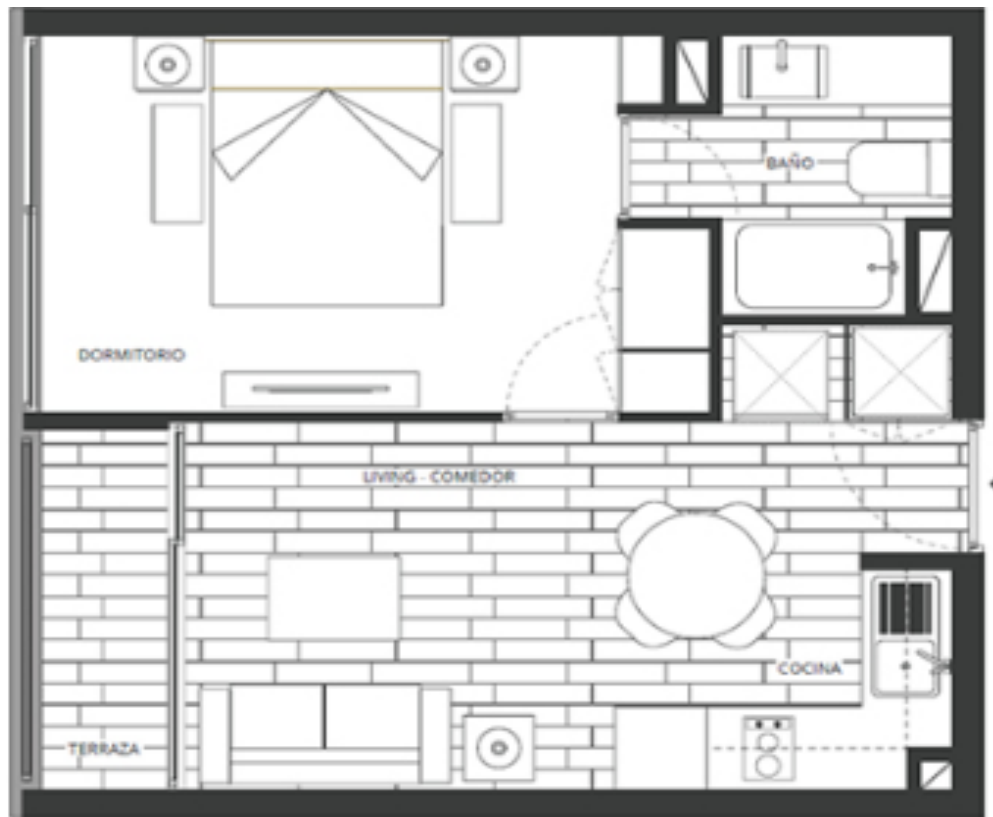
Planta departamento Tipo 1, proyecto Edificio Central
